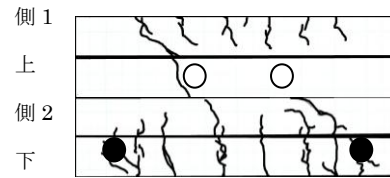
MQT8 ひび割れ図(●: 支点, ○: 載荷点)
